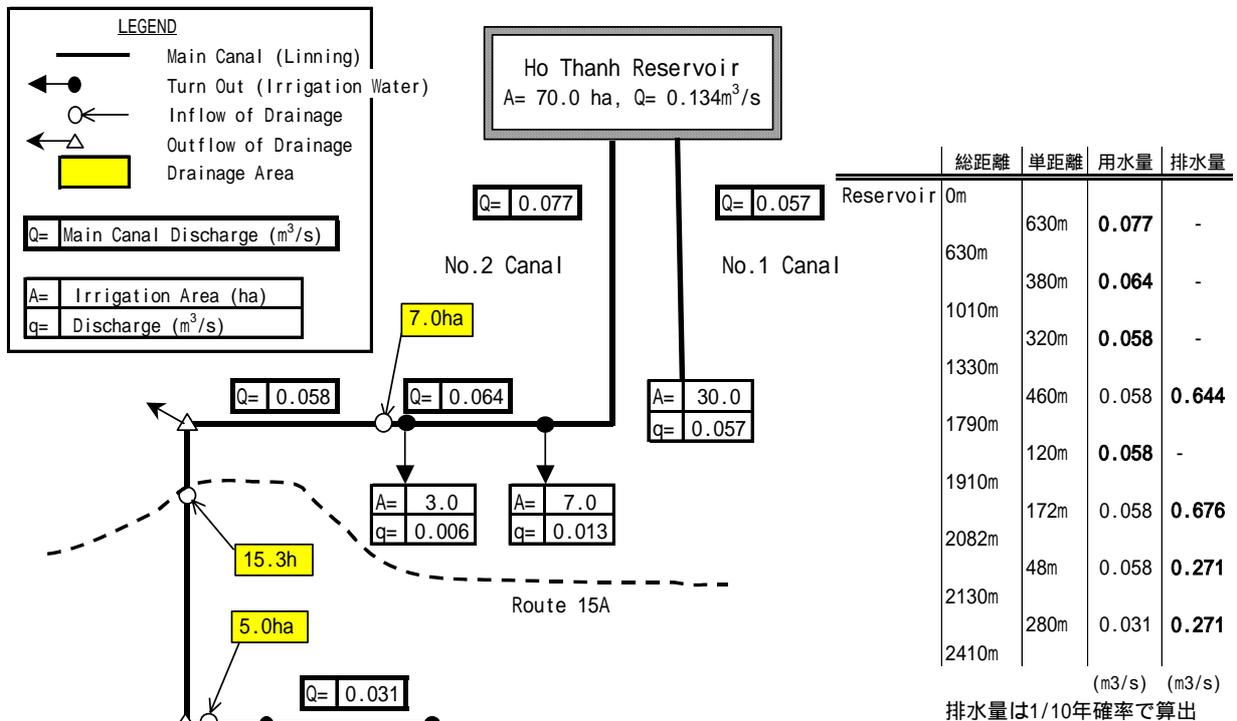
Ho Thanh 掛かり計画灌漑系統および各区間の設計流量
